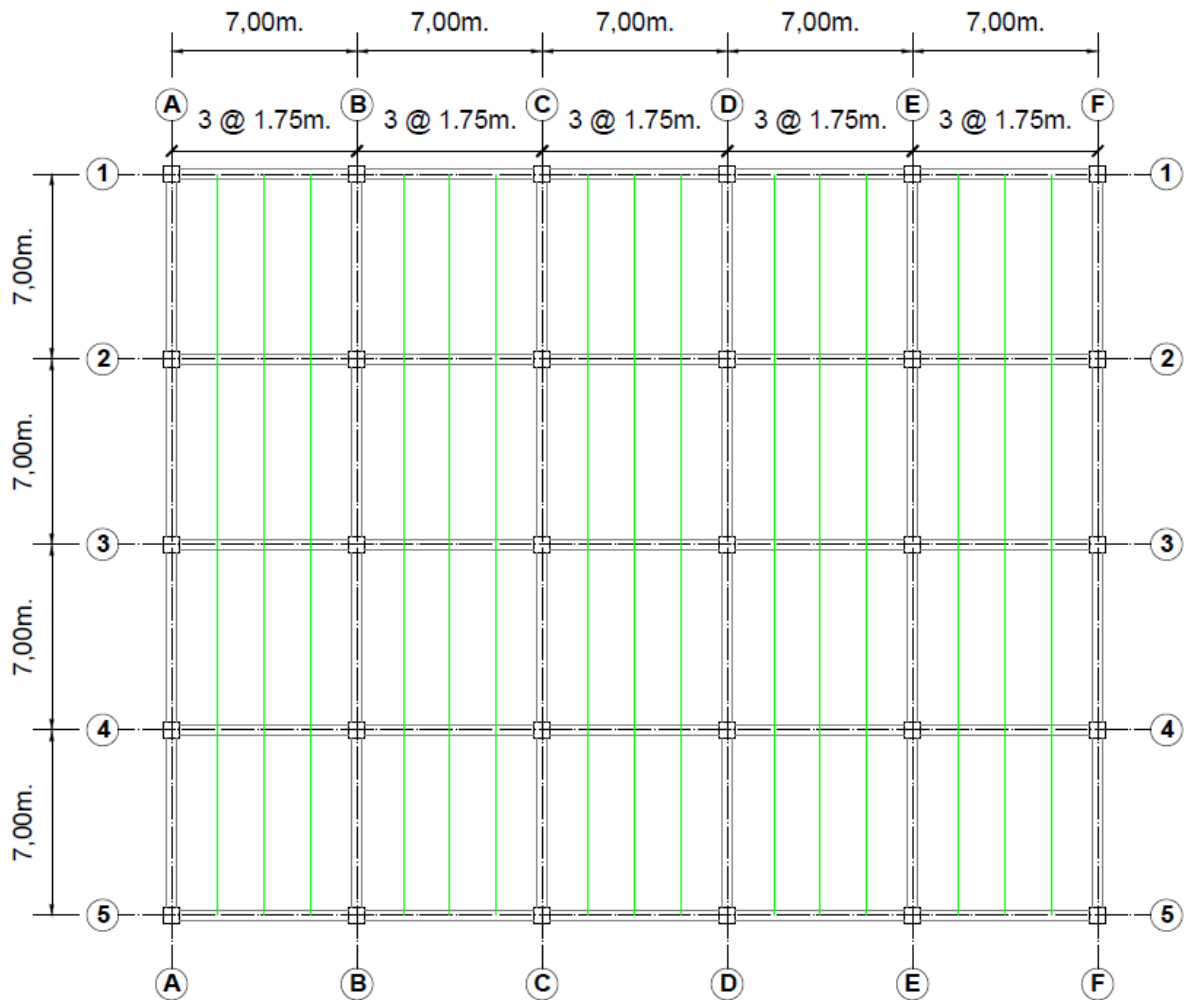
4 Planta tipo edificación en acero estructural y mixta.
